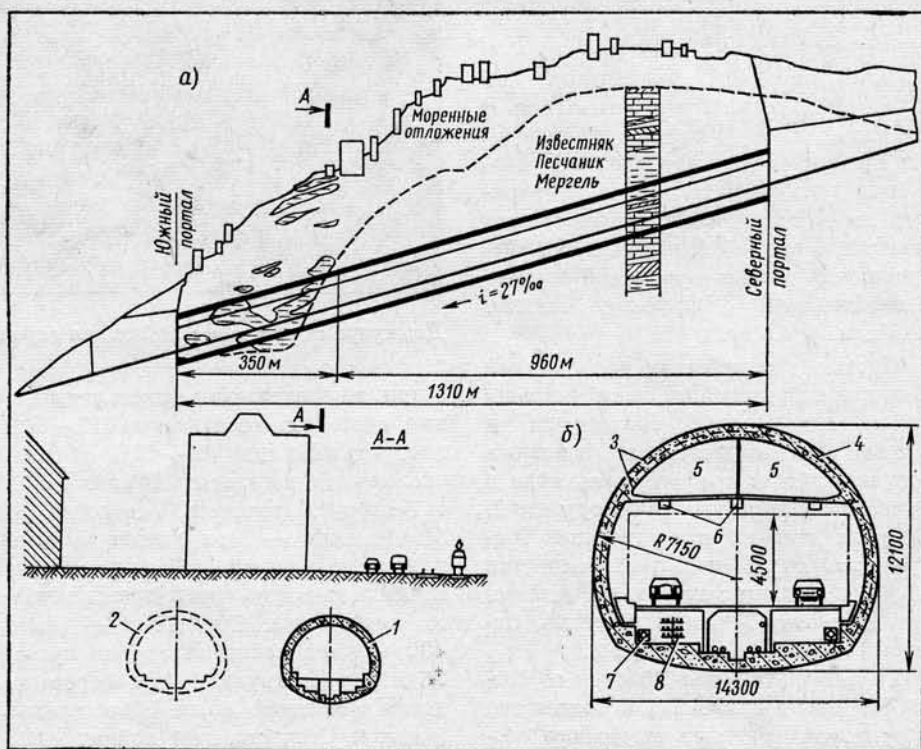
Продольный профиль (а) и поперечное сечение (б) тоннеля Milchbuck: 1 — строящийся тоннель; 2 — проектируемый; 3 — обделка из набрызг-бетона; 4 — гидроизоляция; 5 — вентиляционный канал; 6 — светильники; 7 — водоотводные трубы; 8 — кабели
